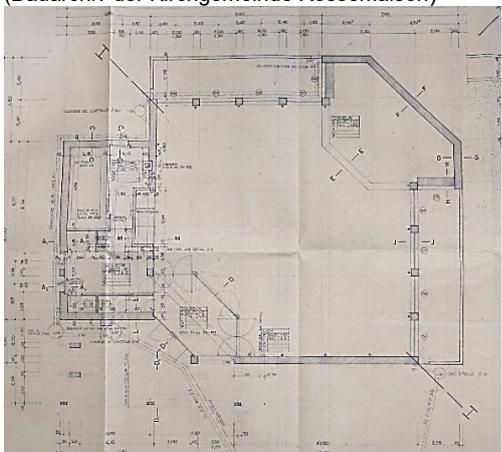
Grundriss, Plan vom 04.03.1968 mit Korrekturen vom 27.09.1968 (Bauarchiv der Kirchgemeinde Rossemaison)
